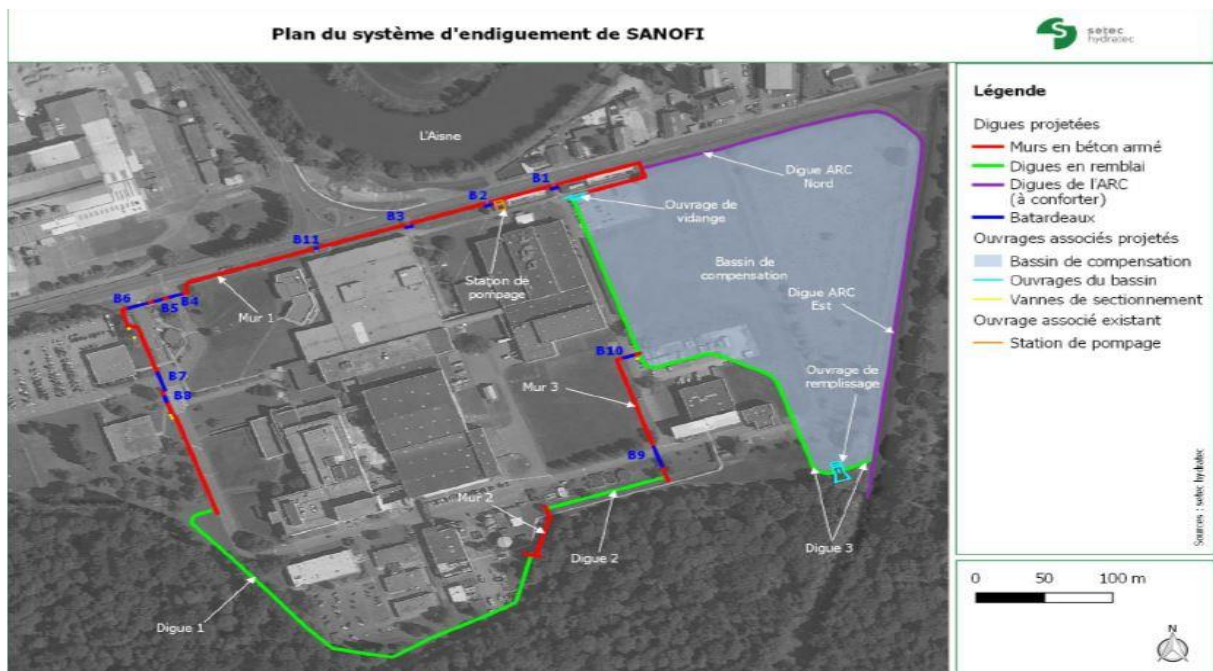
Plan du système d'endiguement – Source : Setec Hydratec
